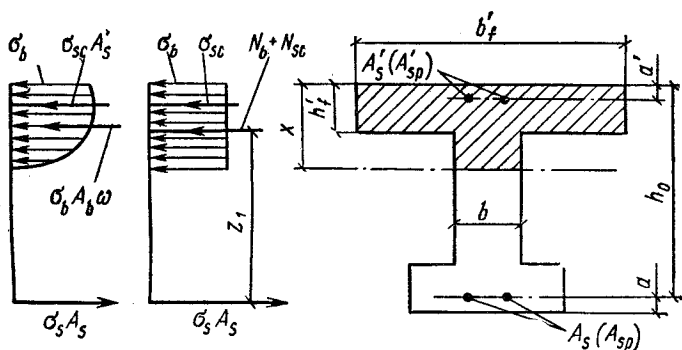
К определению напряжений в бетоне и арматуре элемента таврового сечения с полкой в сжатой зоне
